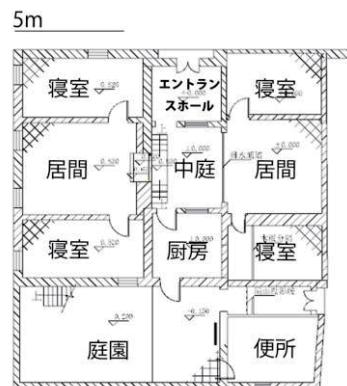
德星里 2 番の平面図（資料提供：中山大学）
